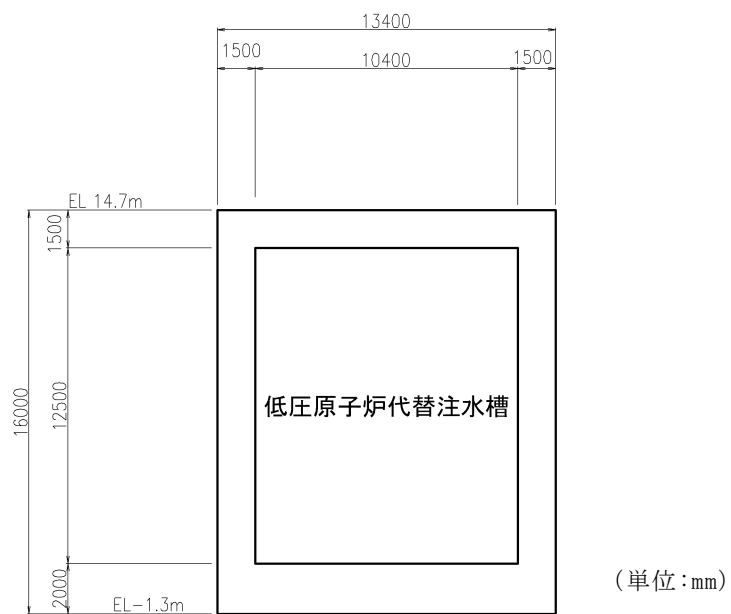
低圧原子炉代替注水ポンプ格納槽 断面図 (B-B 断面)
